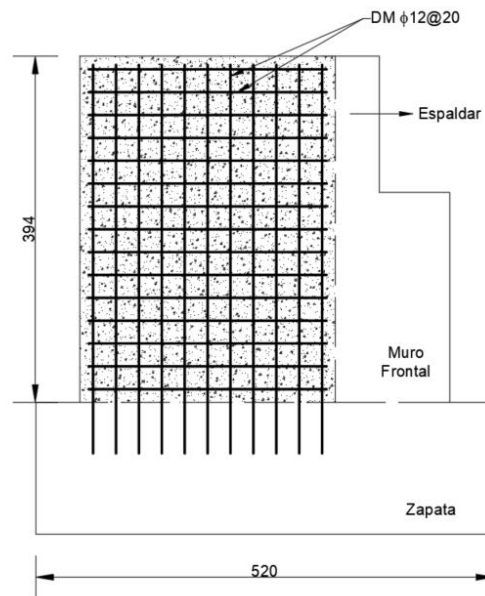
Esquema de la armadura de diseño para el muro frontal y espaldar (dimensiones en cm).
